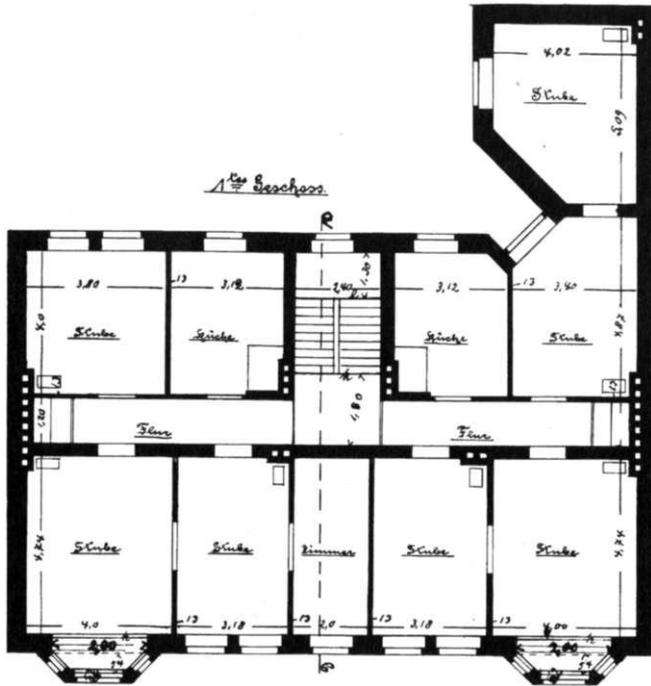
Grundrißtyp D, 1. Geschoß Immermannstraße 22
